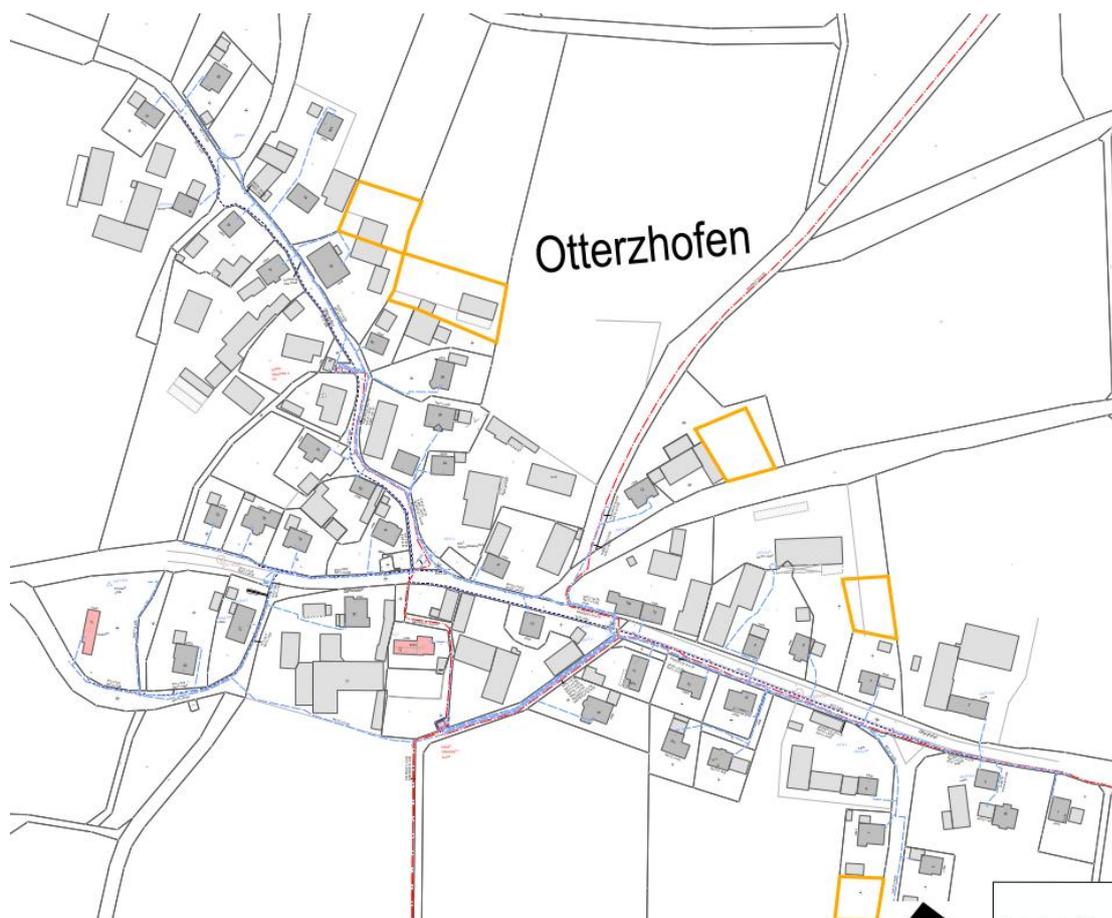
Auszug Lageplan Leitungen Bayernwerk, Quelle: Bayernwerk Netz GmbH (Stand 11/2024)
